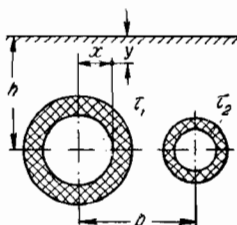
Схема двухтрубного бесканального теплопровода.
